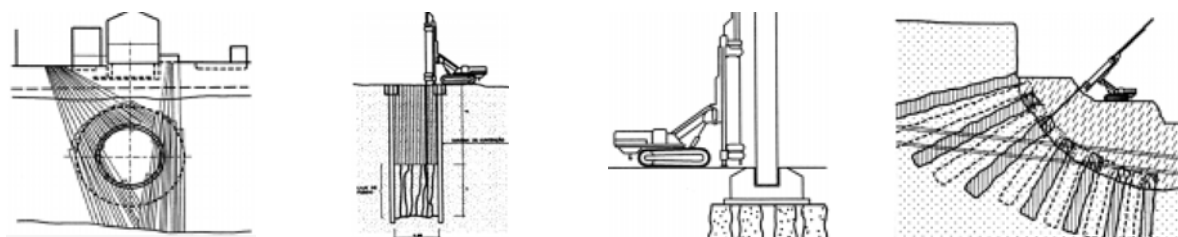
Exemplos de aplicação da técnica do Jet Grouting – Fonte: Joana Rodrigues Carreto
